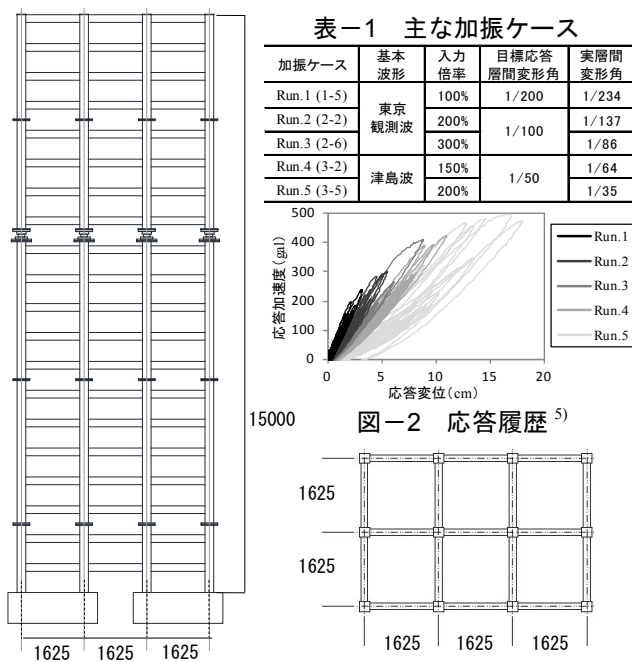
試験体 軸組図・伏図 (単位: mm) ³⁾
